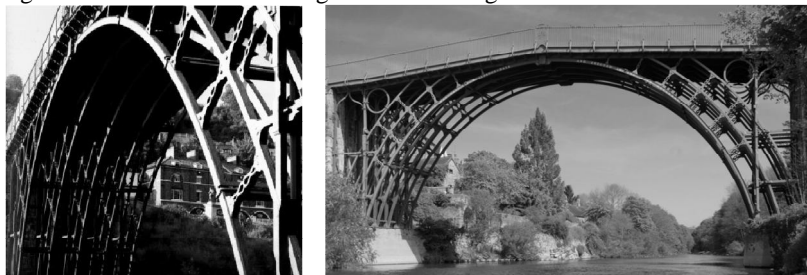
a – Proposta inicial da ponte Ironbridge em 1779 por Pritchard e b – modificação do arco composto por elementos de ferro fundido
